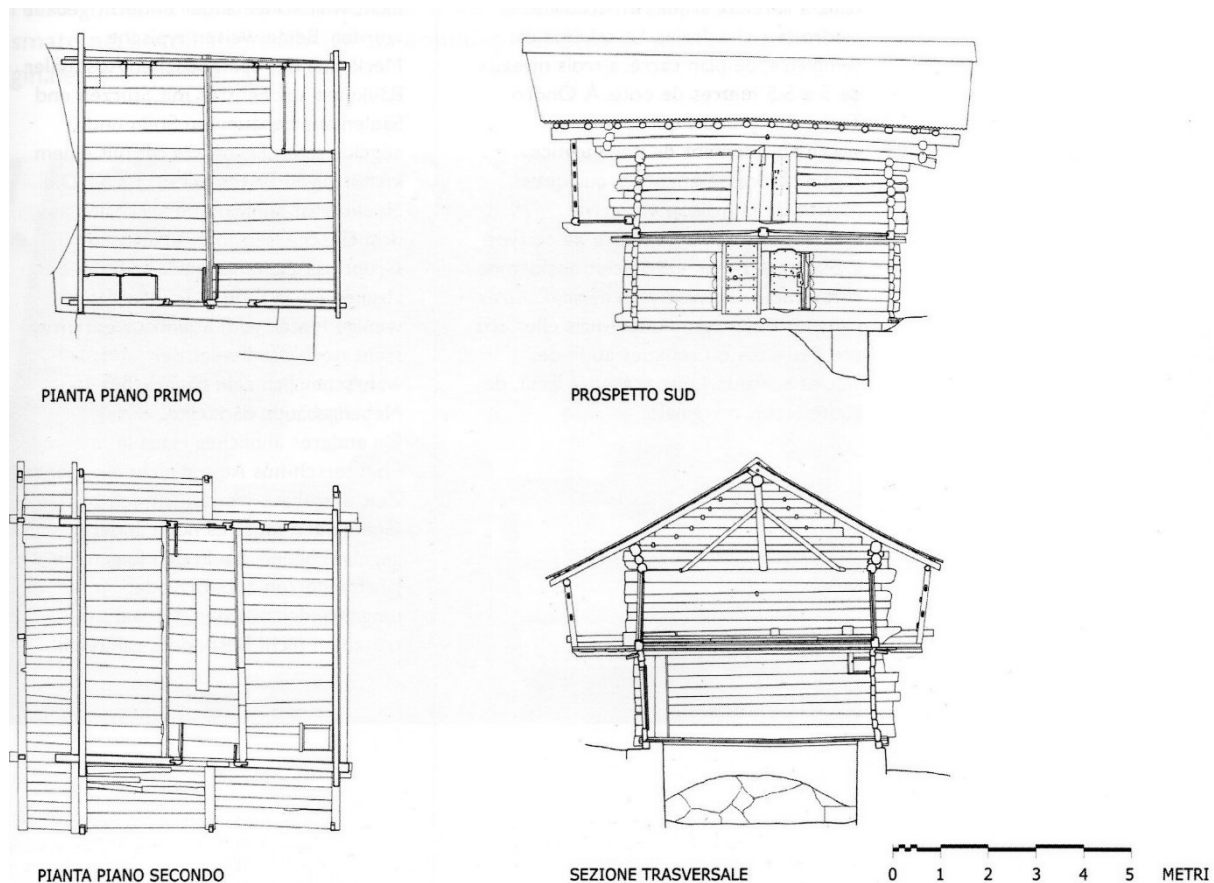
Esempio di abitazione a "Porte gemelle", perfettamente visibili nel prospetto sud
